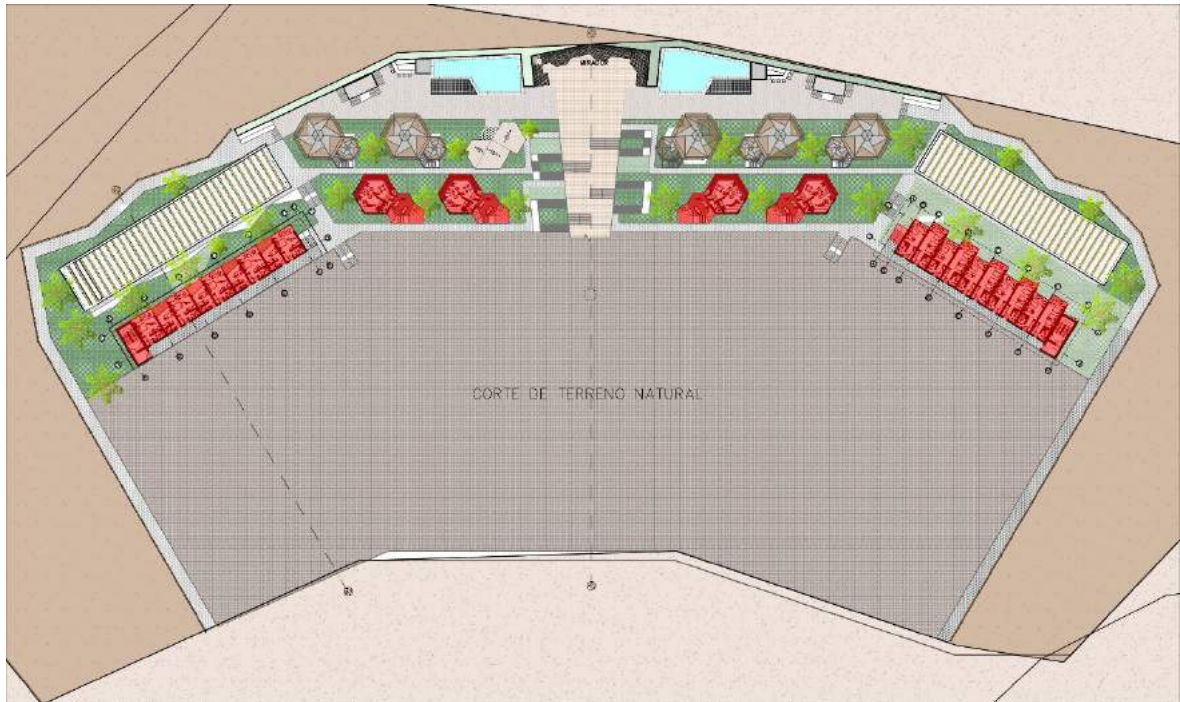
Zonificación Segunda Planta Baja (N.P.T: +24.00m)
